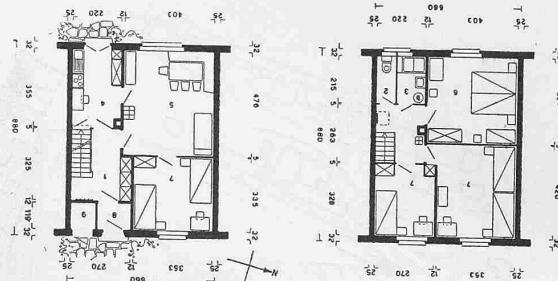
Einfaches Reihenhaus zu 5 Zimmern Typ H
